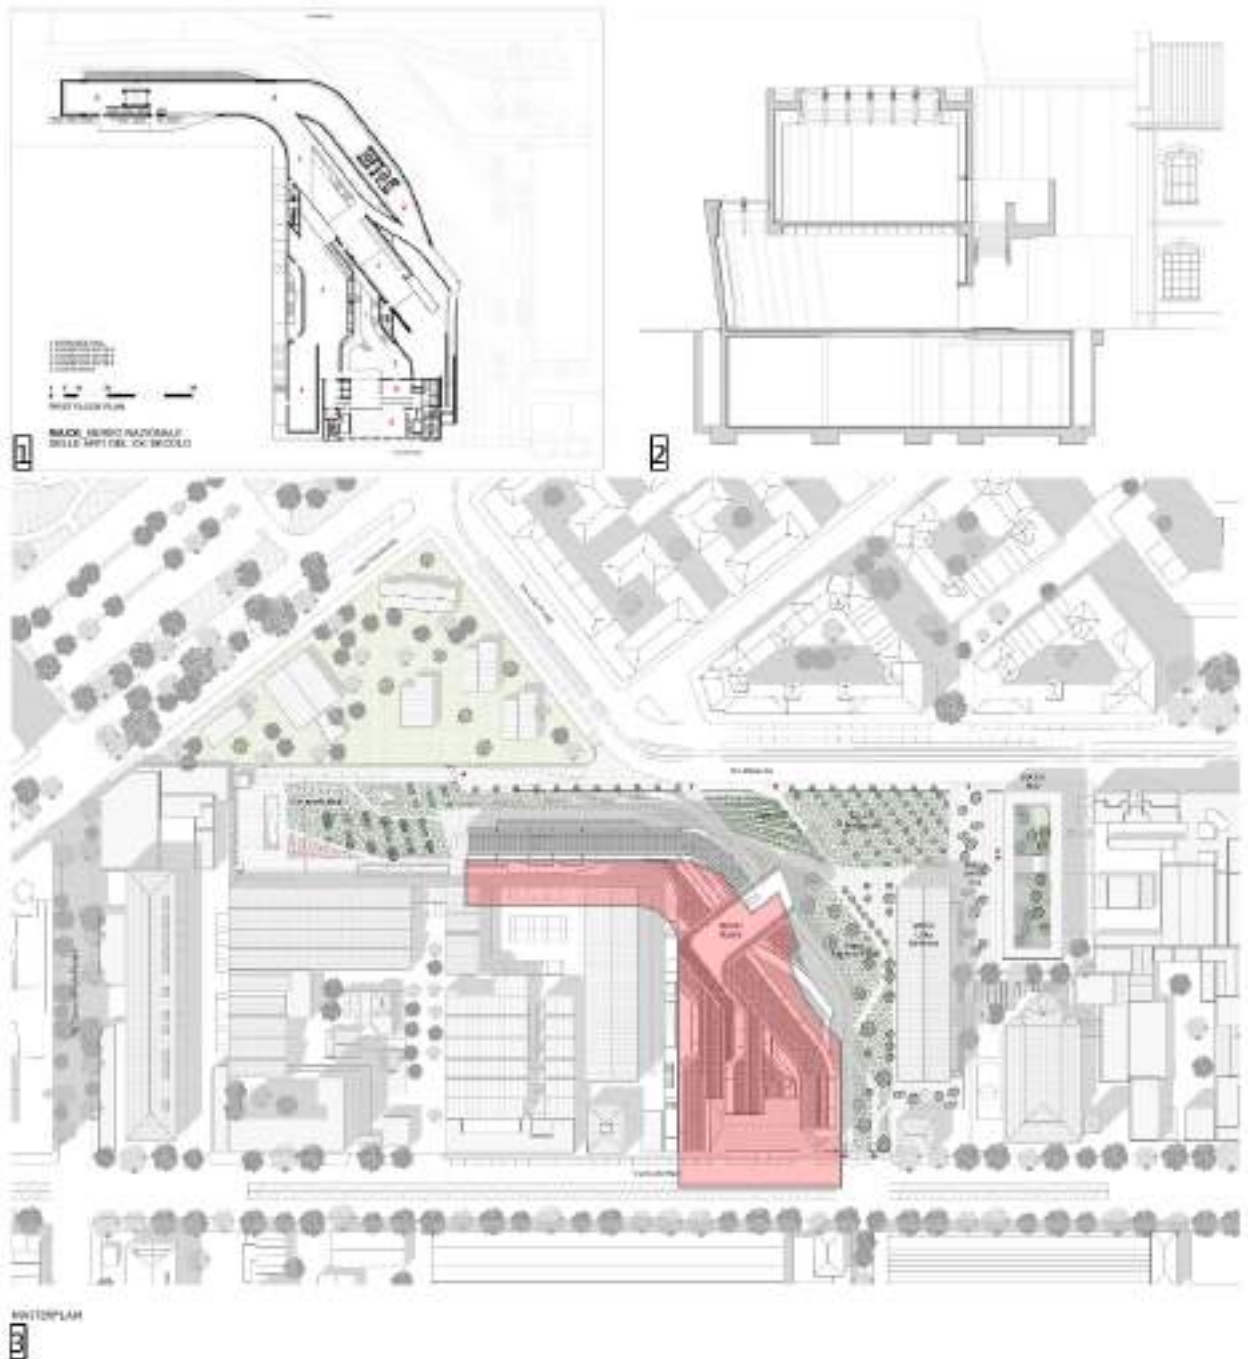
План будівлі, Рис.2- Розріз, Рис.3- Генплан [23].
